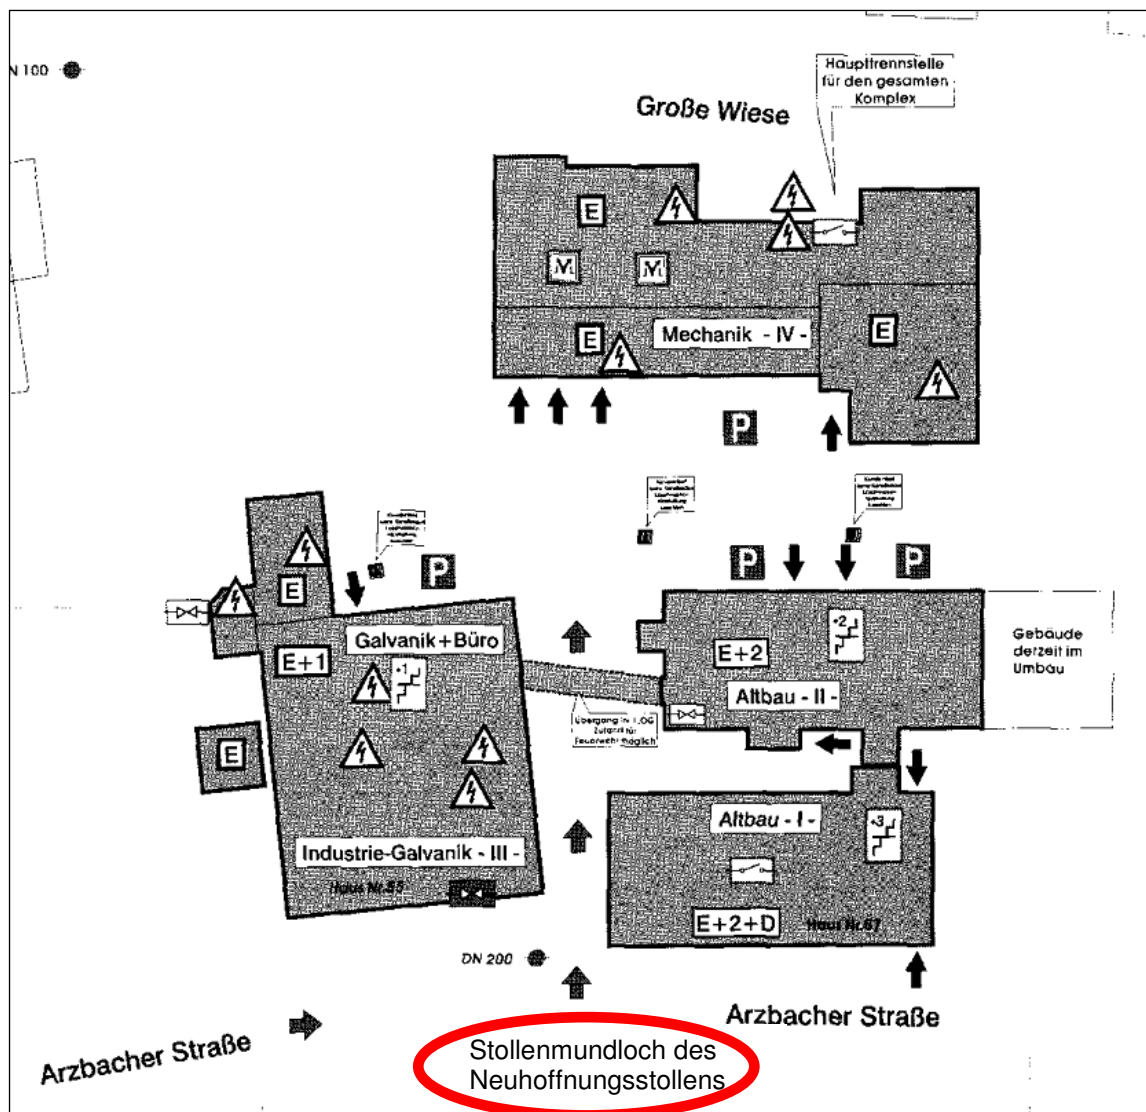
Lageplan der Gebäude auf dem Firmengelände der FIS GmbH
